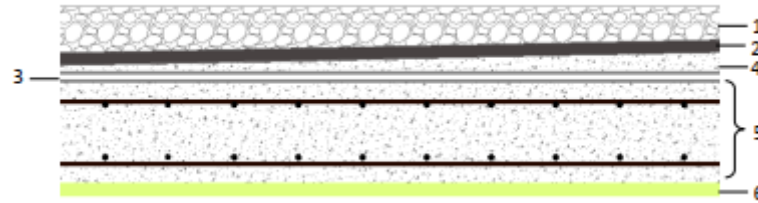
Composants d'un balcon terrasse en dalle pleine
